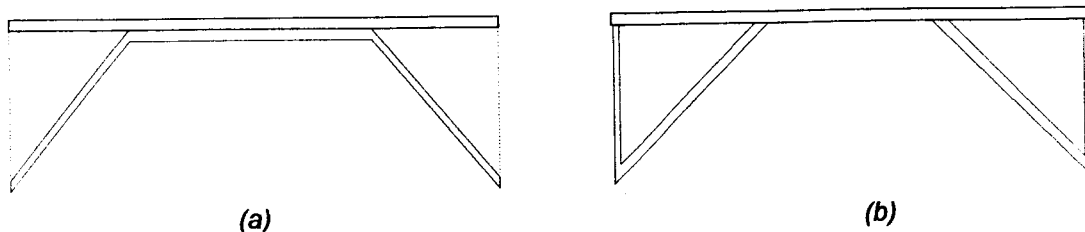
Pórticos longitudinais: (a) Pórtico acrescentado às vigas.
